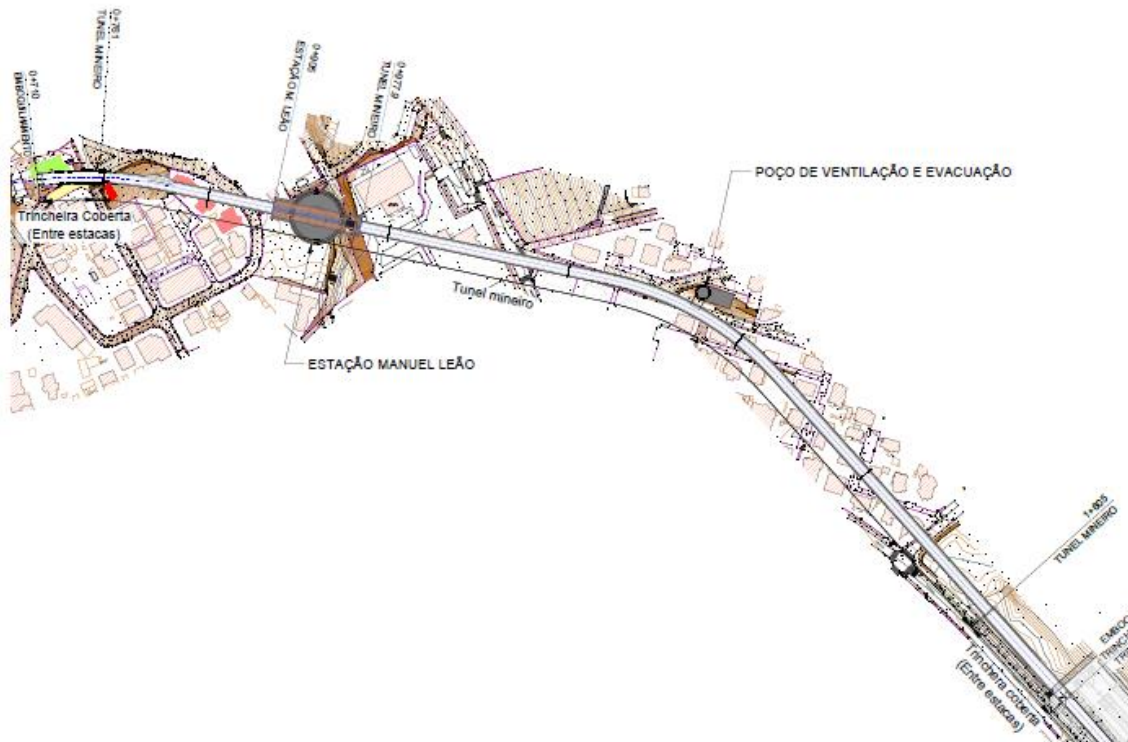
Planta Geral Traçado Subterrâneo
